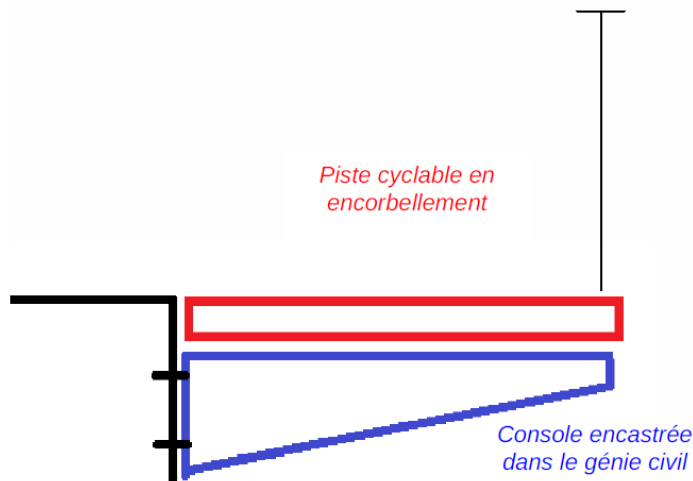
Coupe de principe de la piste en encorbellement du génie civil
